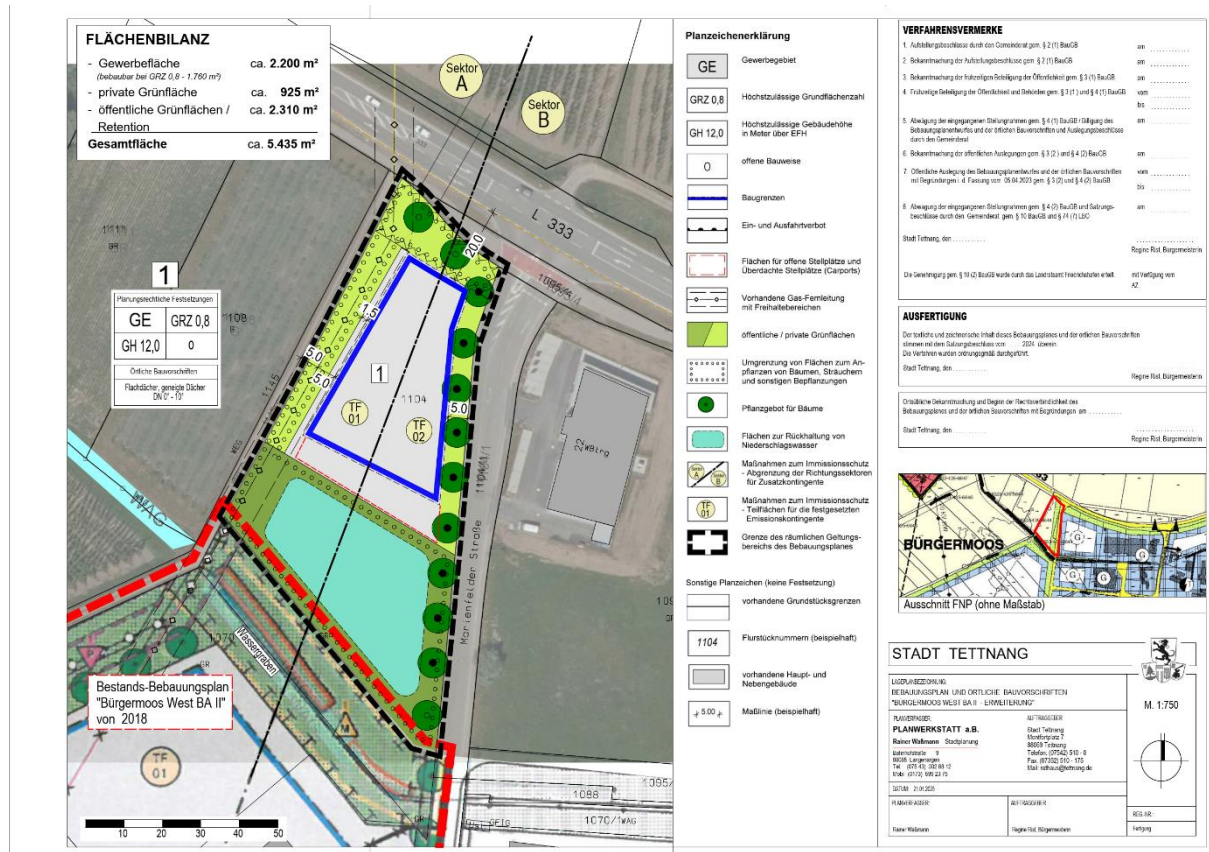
Plan-Darstellung des Bebauungsplans (Entwurf vom 21.1.2025).
